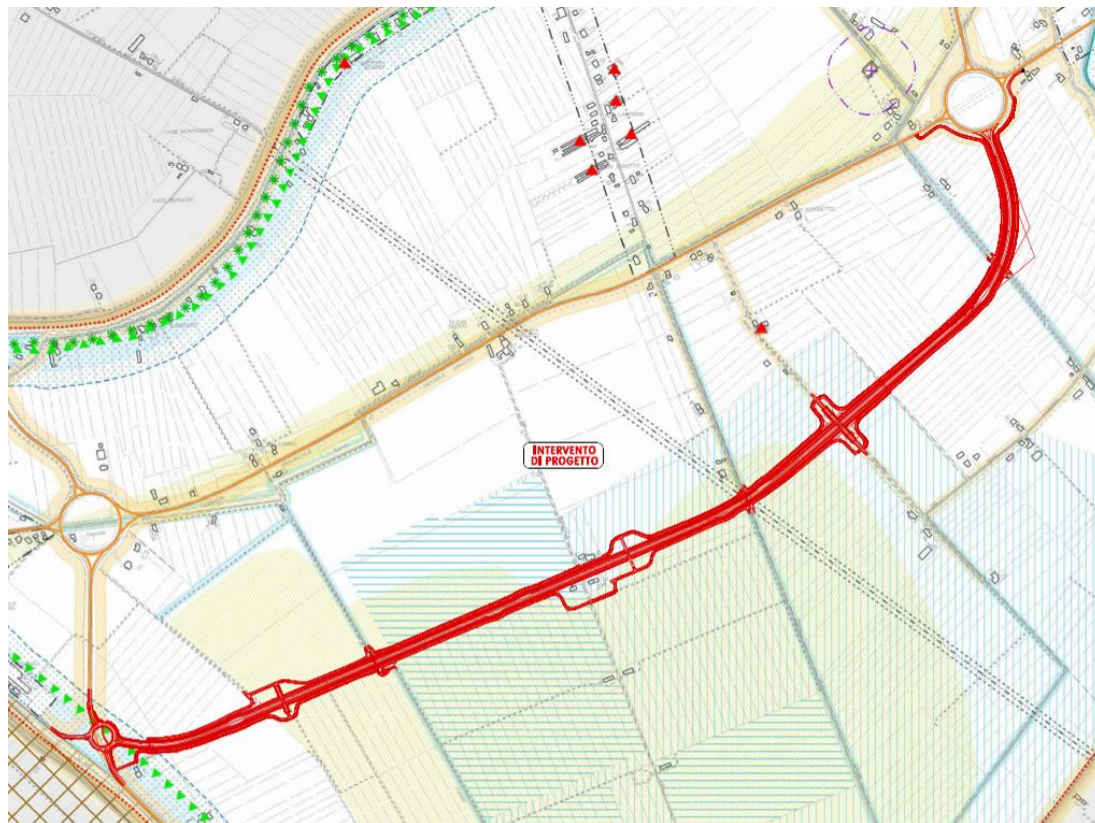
STRALCIO TAV 1 PAT SAN DONÀ DI PIAVE – LOCALITÀ ARMELLINA
